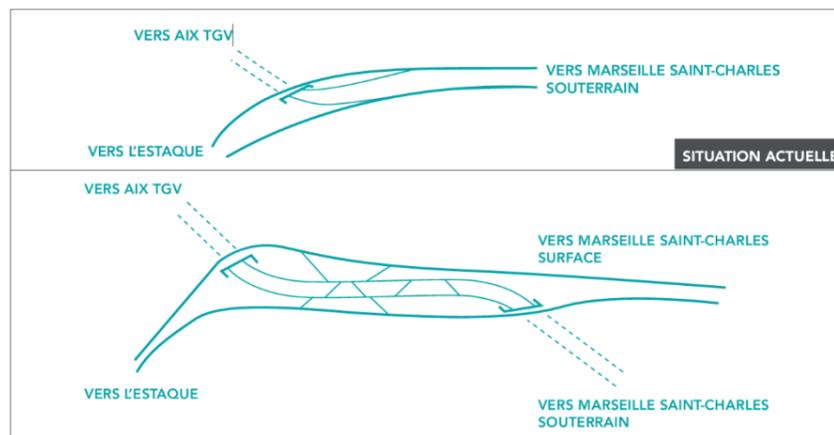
Schéma du raccordement d'entrée en tunnel au droit de la Delorme (source : dossier de concertation 2021)
